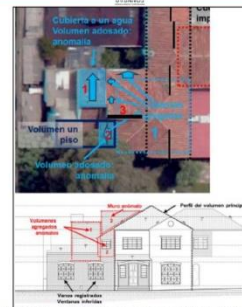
Fachada principal: volúmenes agregados y muro en cubierta, anomalías
